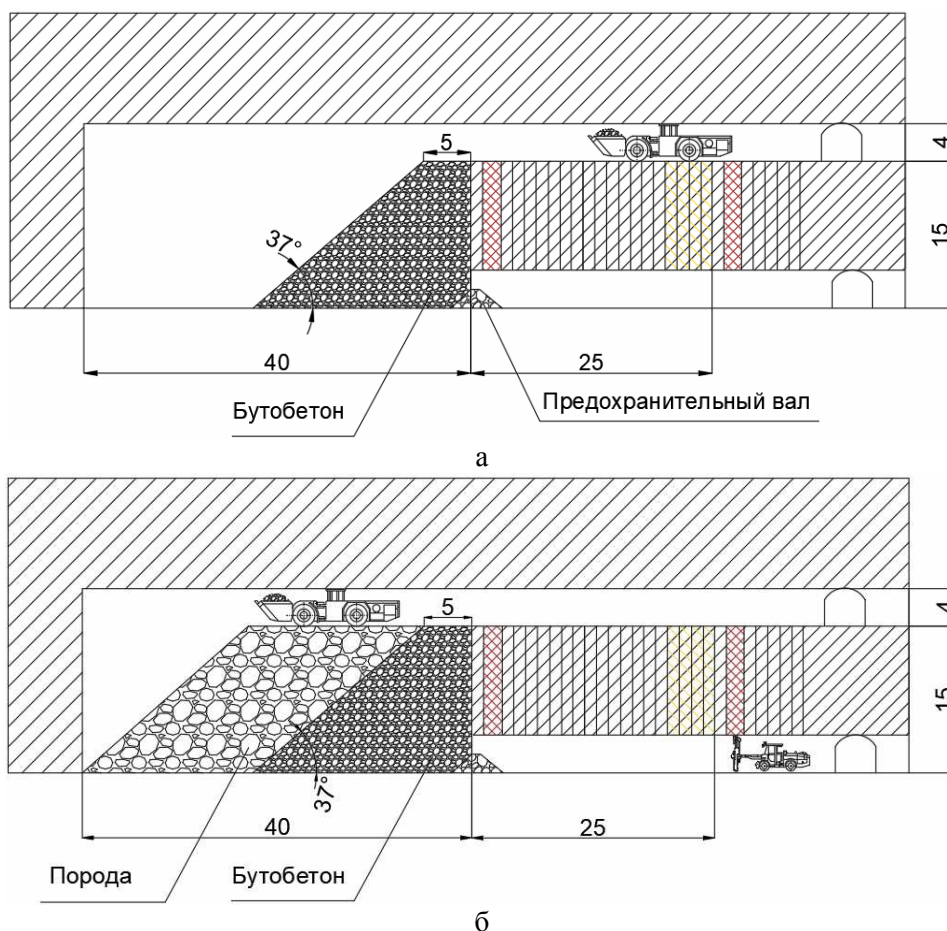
Вариант системы разработки с формированием закладочного массива из бутобетонной твердеющей смеси: а – формирование бутобетонного целика, б – закладка очистного пространства породой
